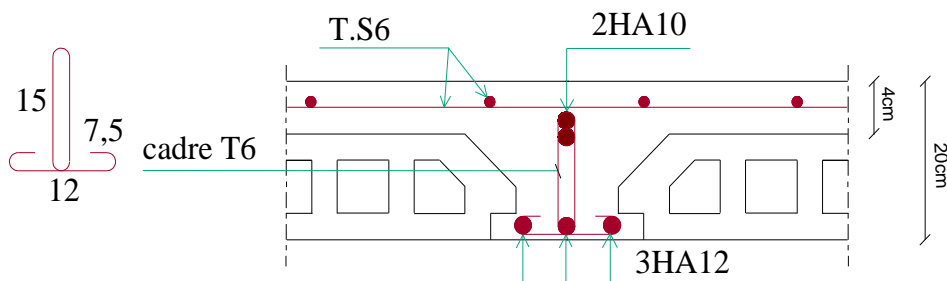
Schéma de ferrailage des poutrelles en appui.
